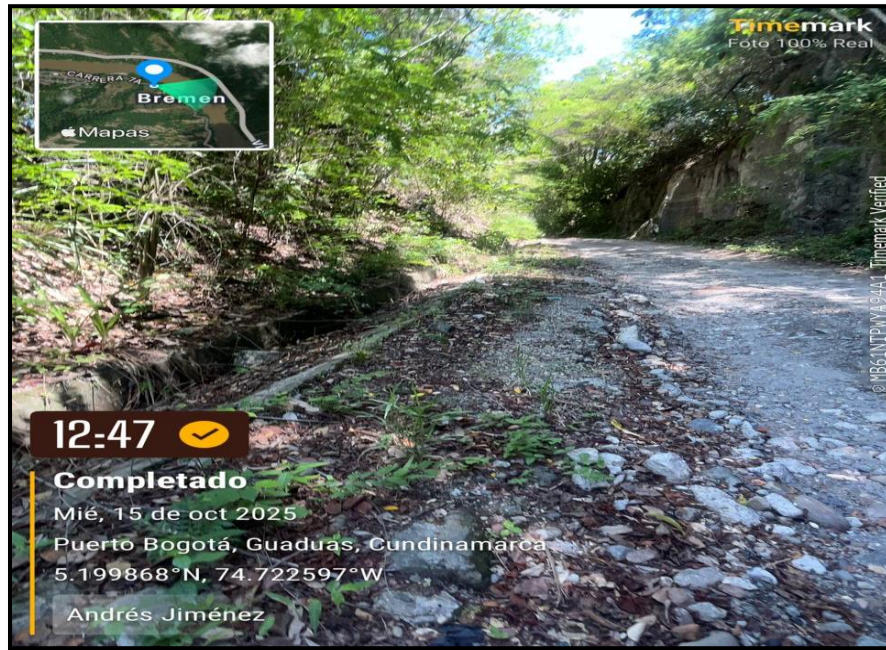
Estado superficial del pavimento, presencia de baches fisuras, hundimientos y pérdida de material granular.
